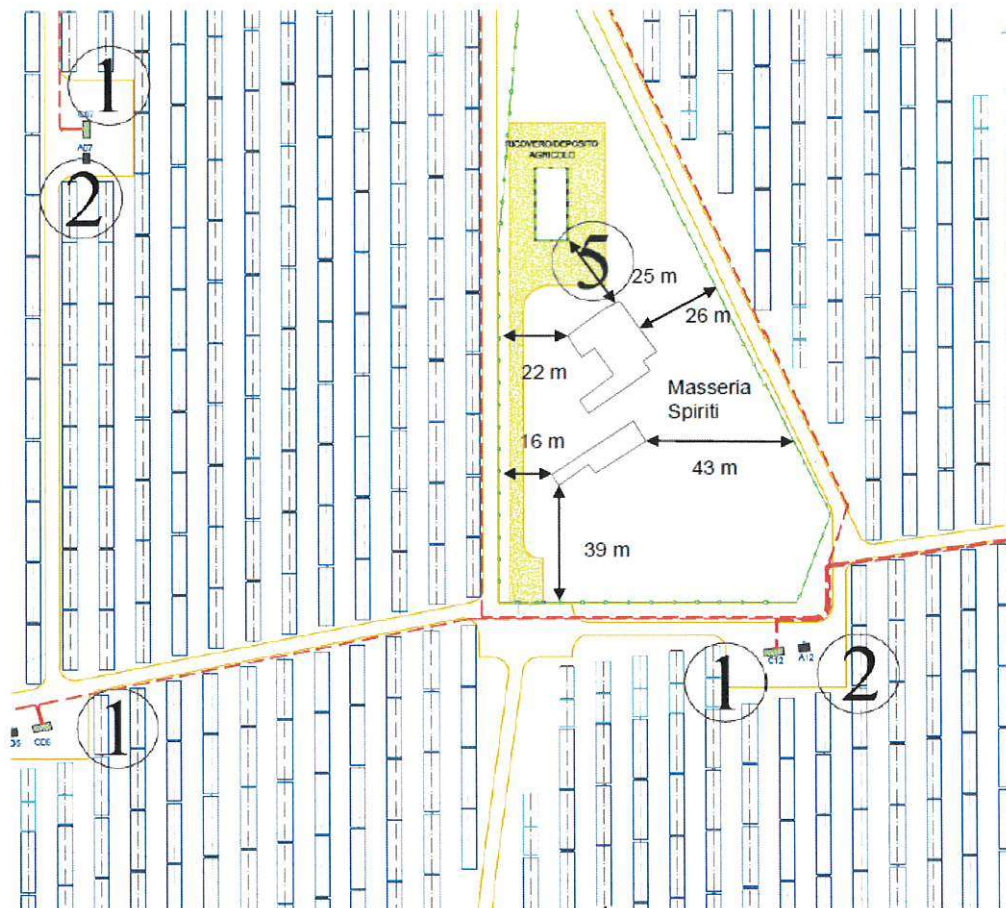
Stralcio Relazione Paesaggistica Appendice 4 – particolare planimetria Masseria Spiriti, locale attrezzi e impianto agro-fotovoltaico
